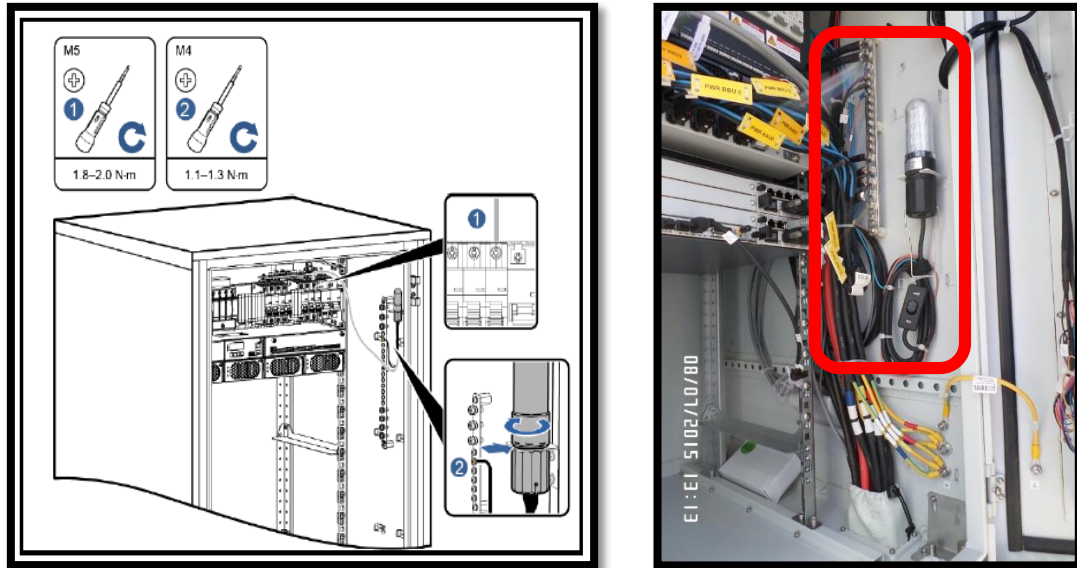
Instalación de la lámpara de la mano en el site Santa Teresa
